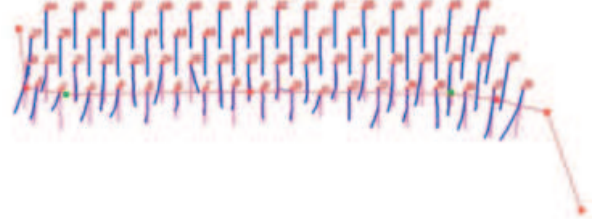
Plán odstřelu v 3D nahraný do vrtací soupravy
